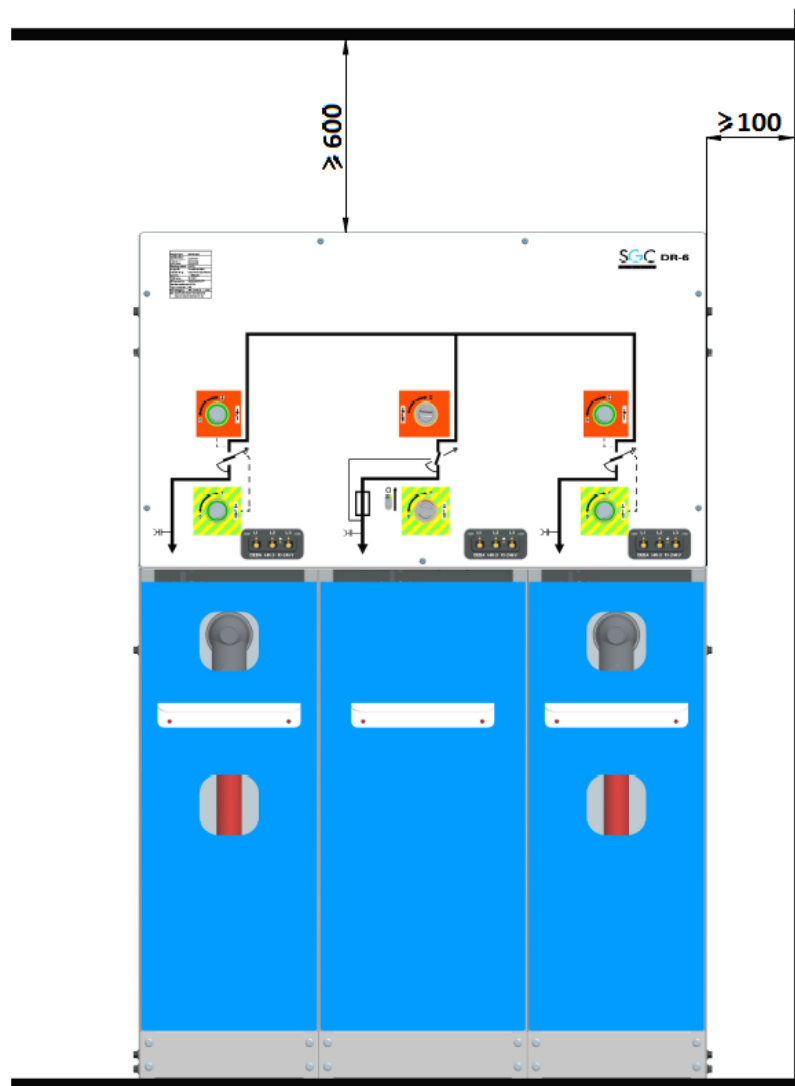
Espace libre au minimum ≥ 600 avec une installation DR-6C/DR-6+C
